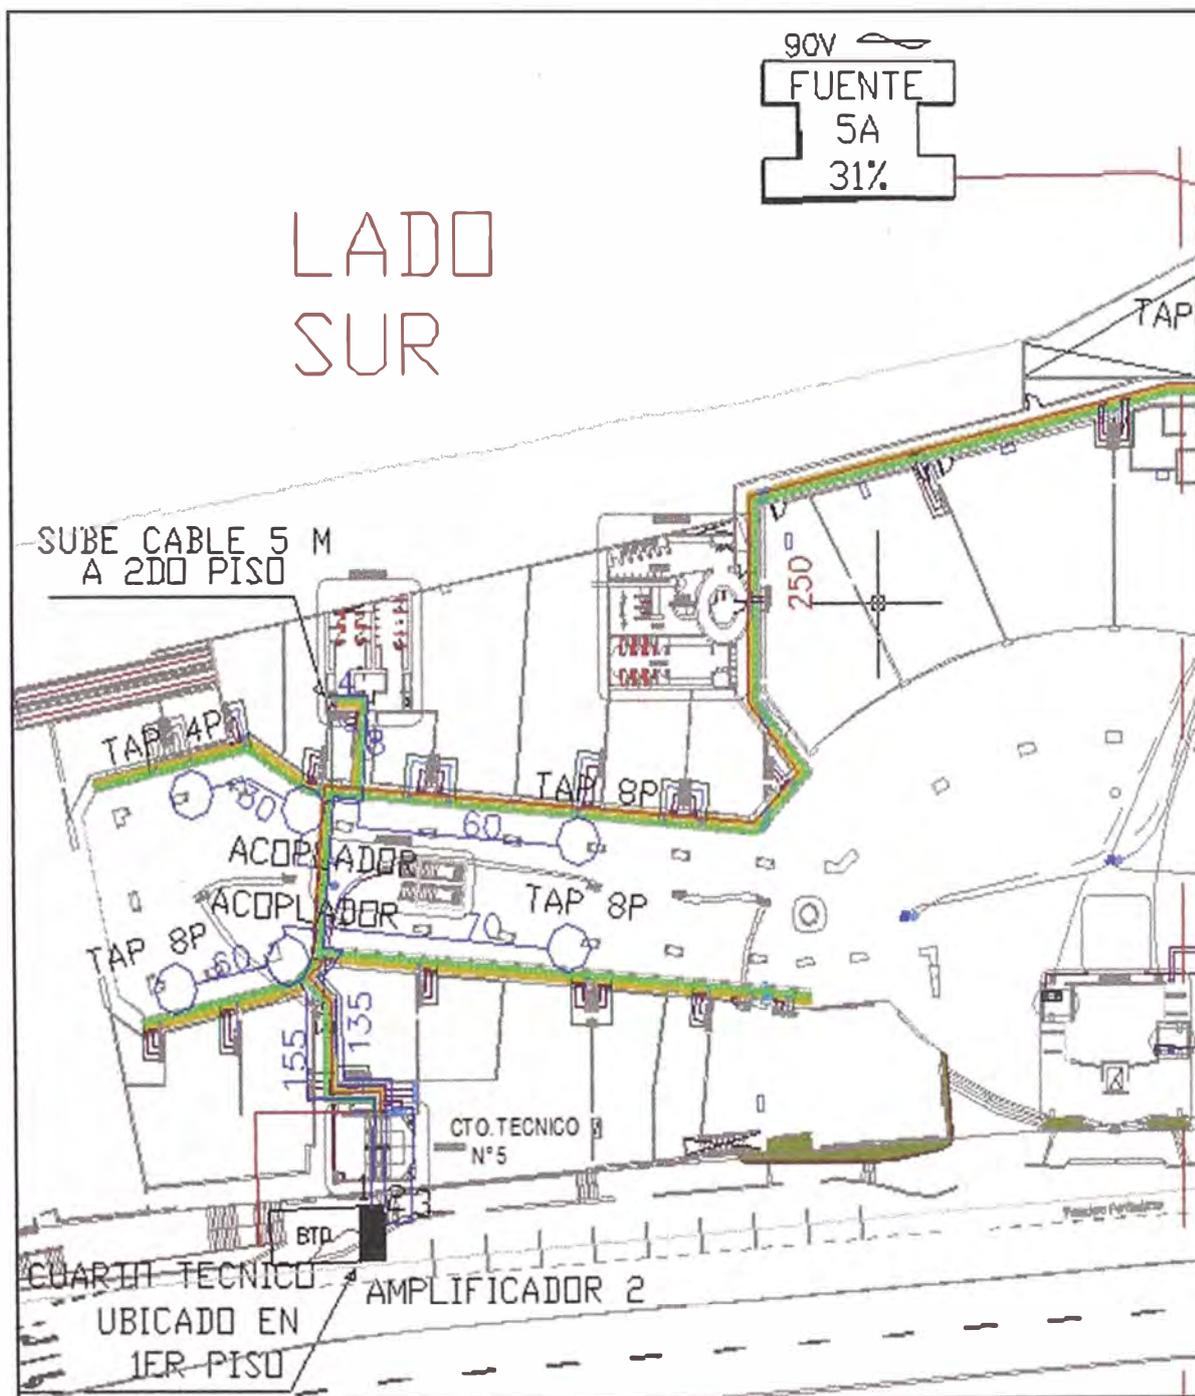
Planta baja del sector sur del C.C. Comercial Parque Lambramani. Fuente: Elaboración propia.
